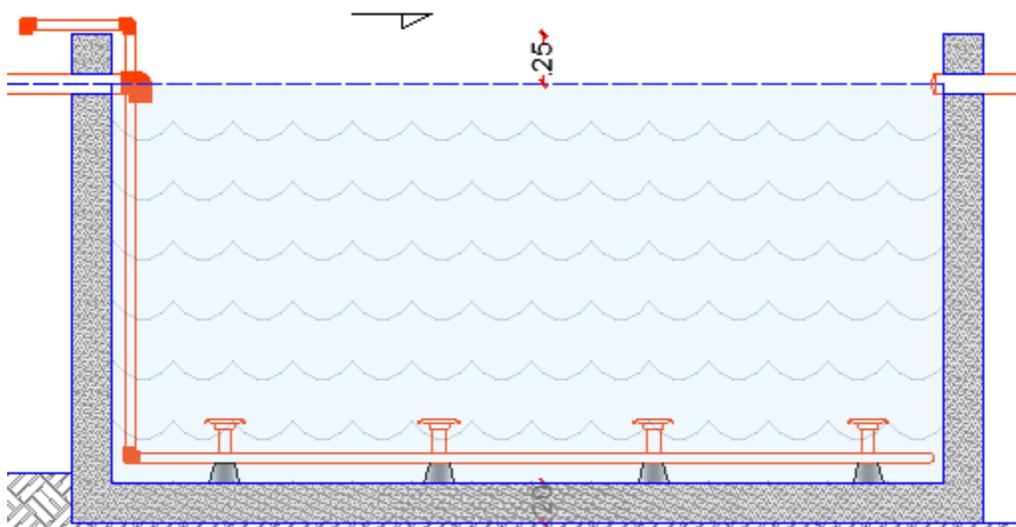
Tanque de Aireación (Perfil Longitudinal, con Detalle Anclaje de Difusores).
